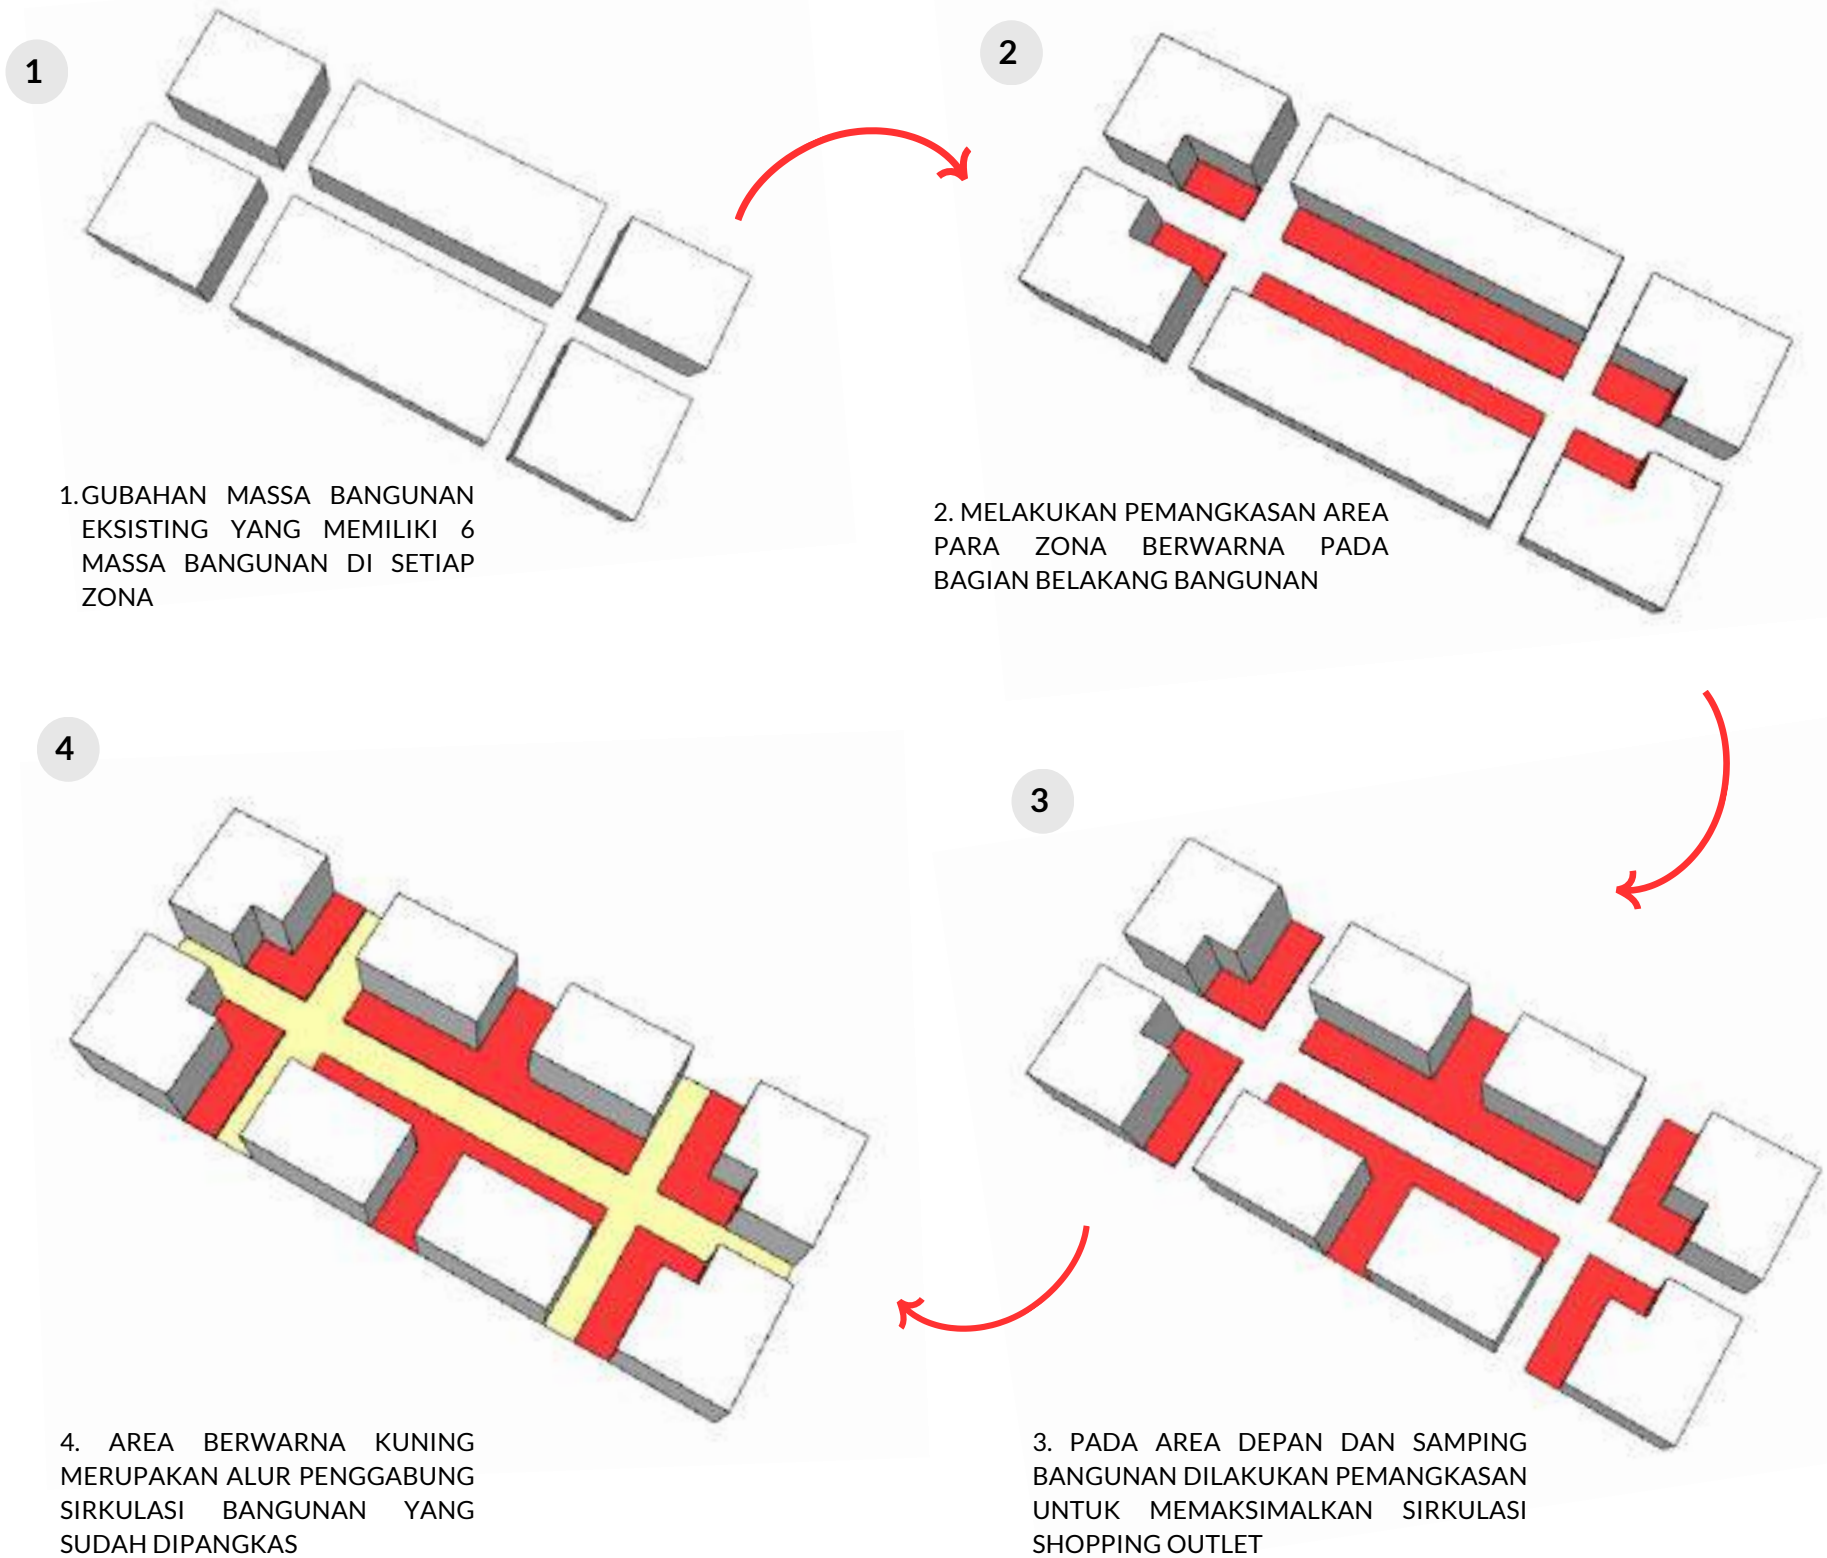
Mempertahankan Struktur B. Eksisting. Sumber : Penulis
